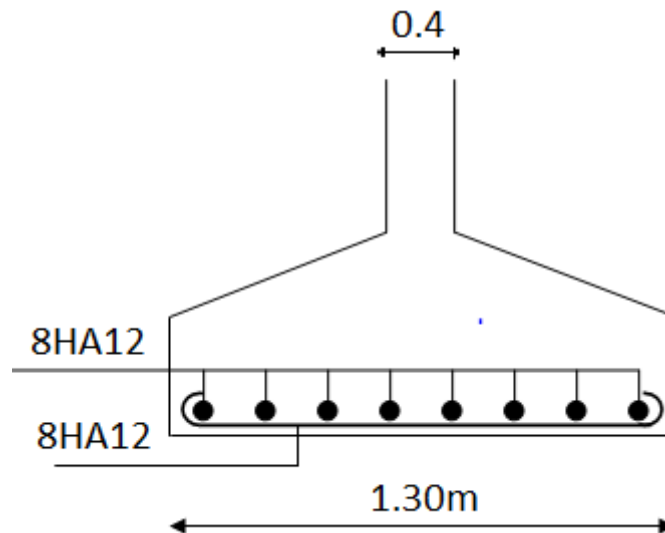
Schéma de ferrailage de la semelle type 1.
